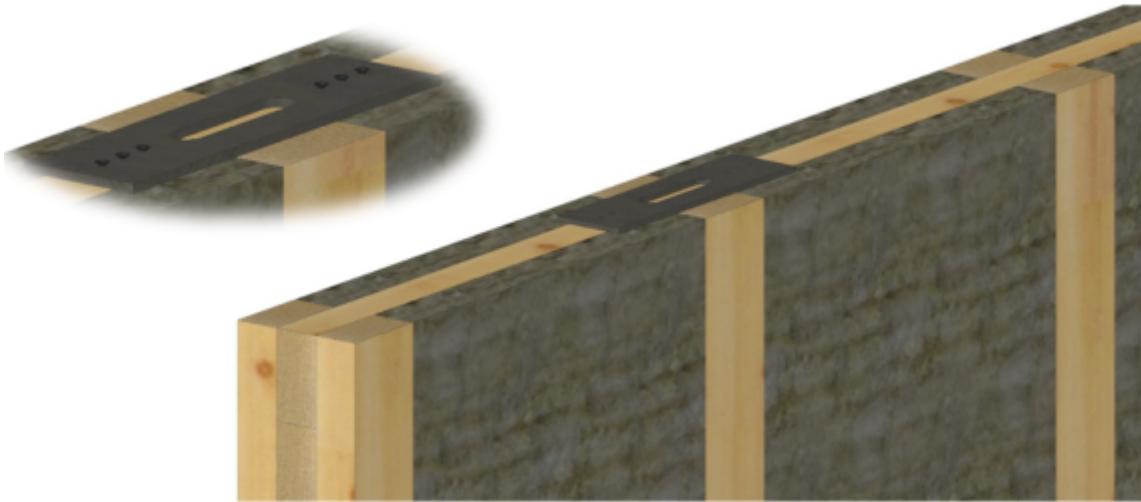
Etrier pré-intégré sur la tranche supérieure du panneau
